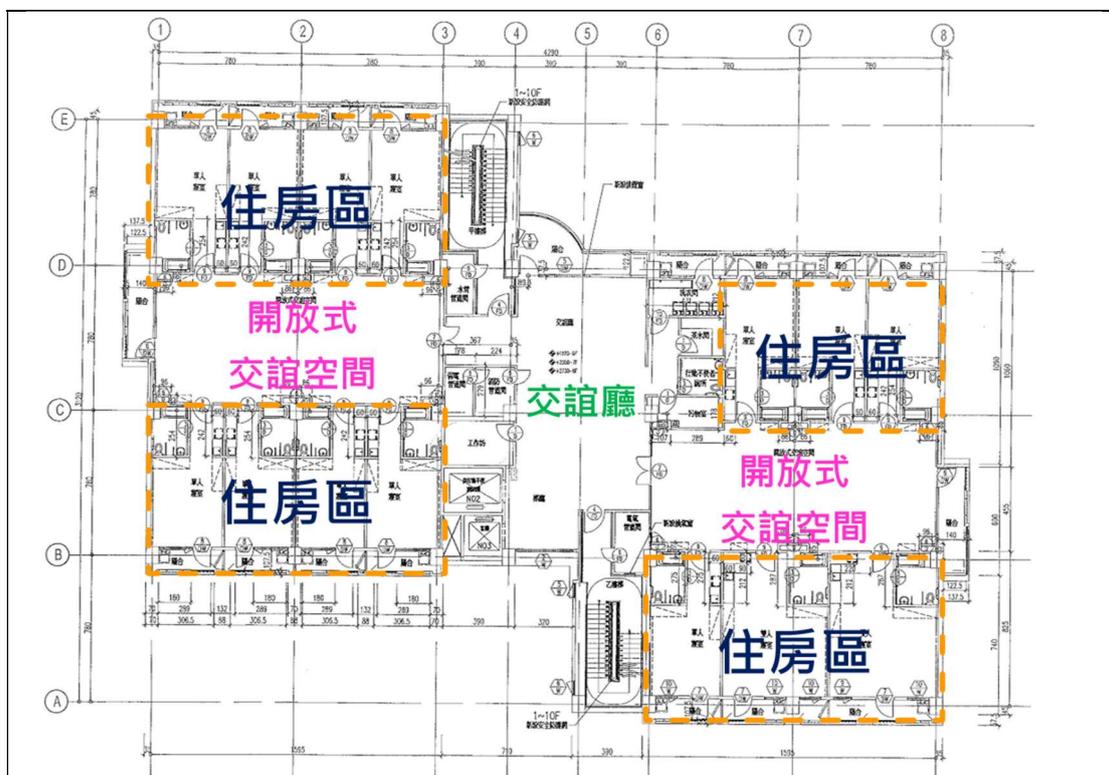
大龍峒老人住宅五至九層規劃平面圖
